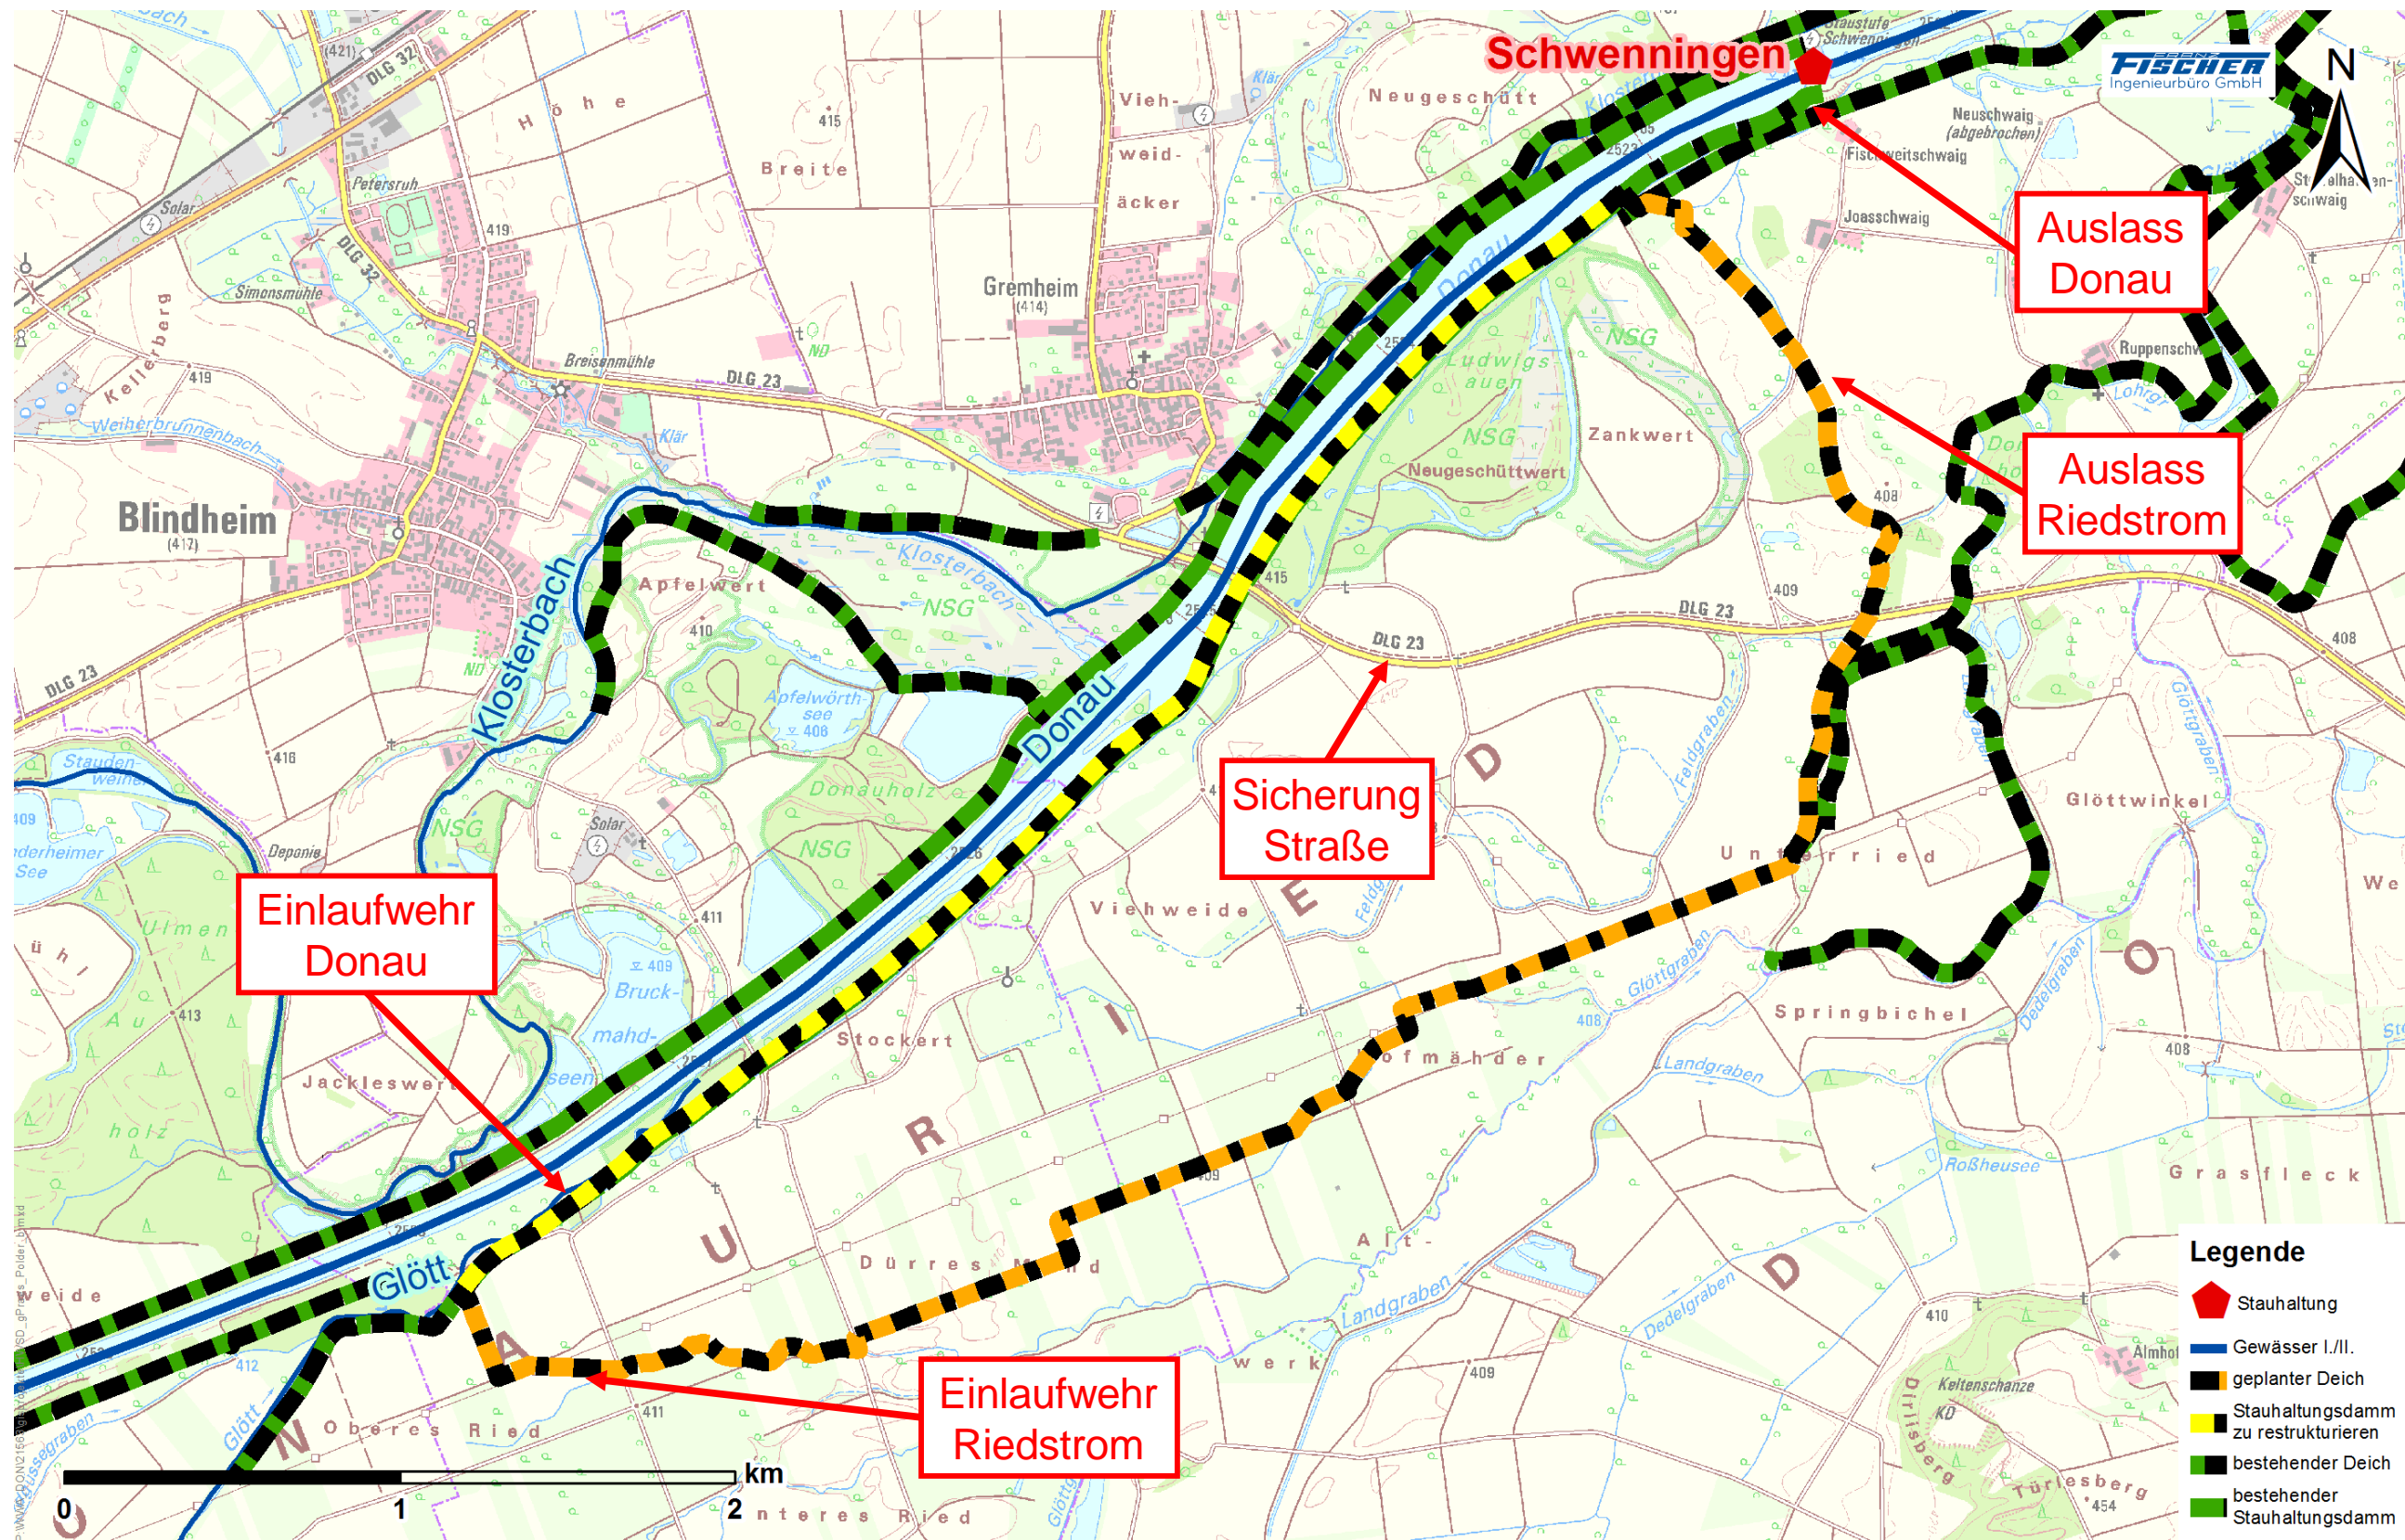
Lageplan des Polders Neugeschüttwörth a
